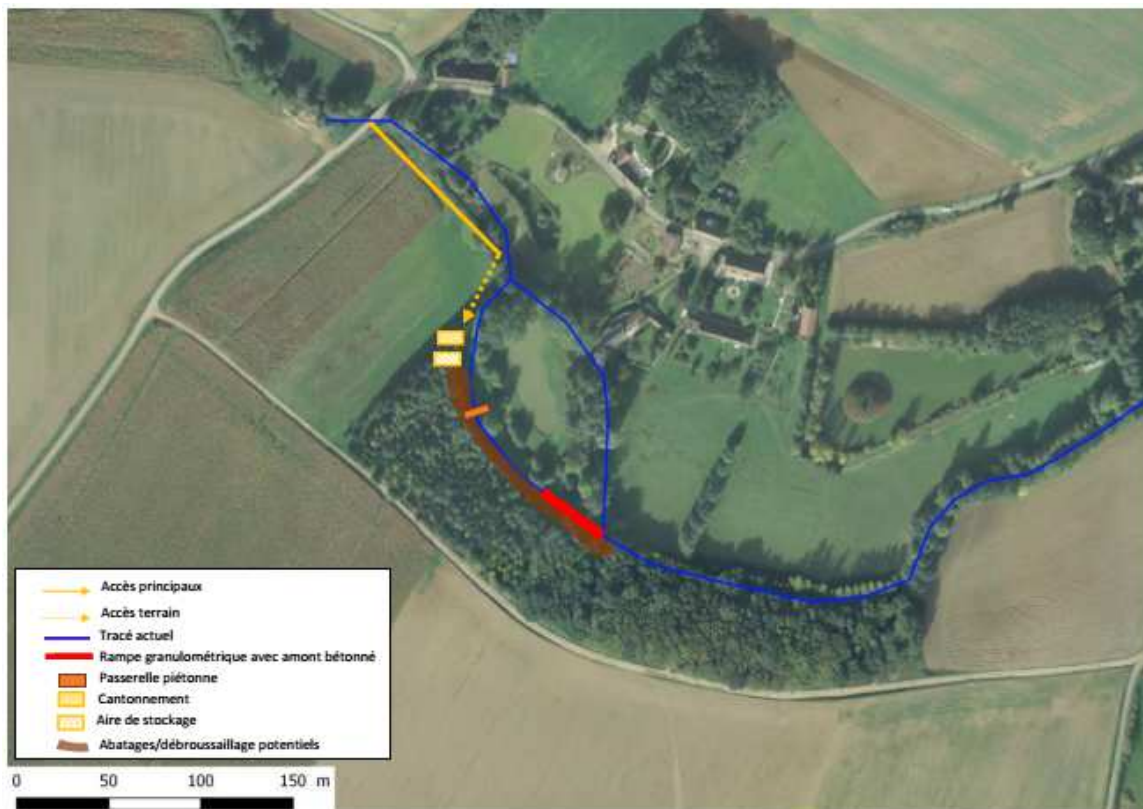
Accès et installations de chantier sur le site du moulin Bondon
